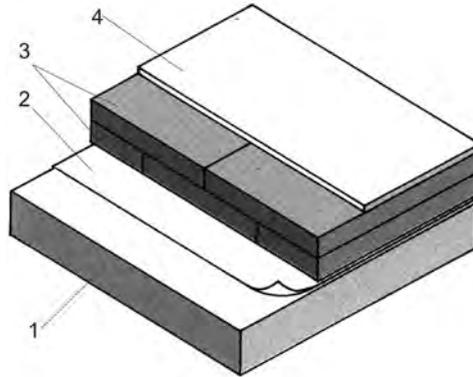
Теплоизоляция межэтажных перекрытий верхних этажей и чердачных перекрытий: 1 — железобетонная плита; 2 — гидроизоляция; 3 — теплоизолирующие плиты или маты; 4 — напольное плитное покрытие
